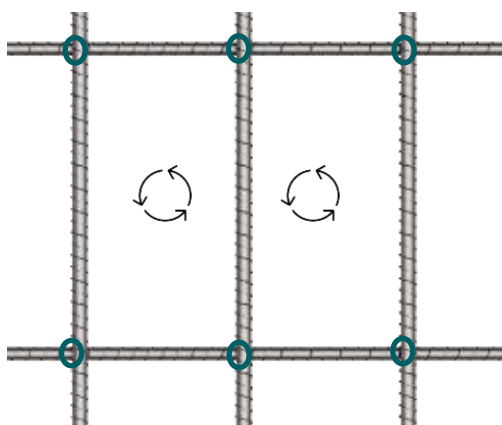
Barras de refuerzo soldadas o cableadas
